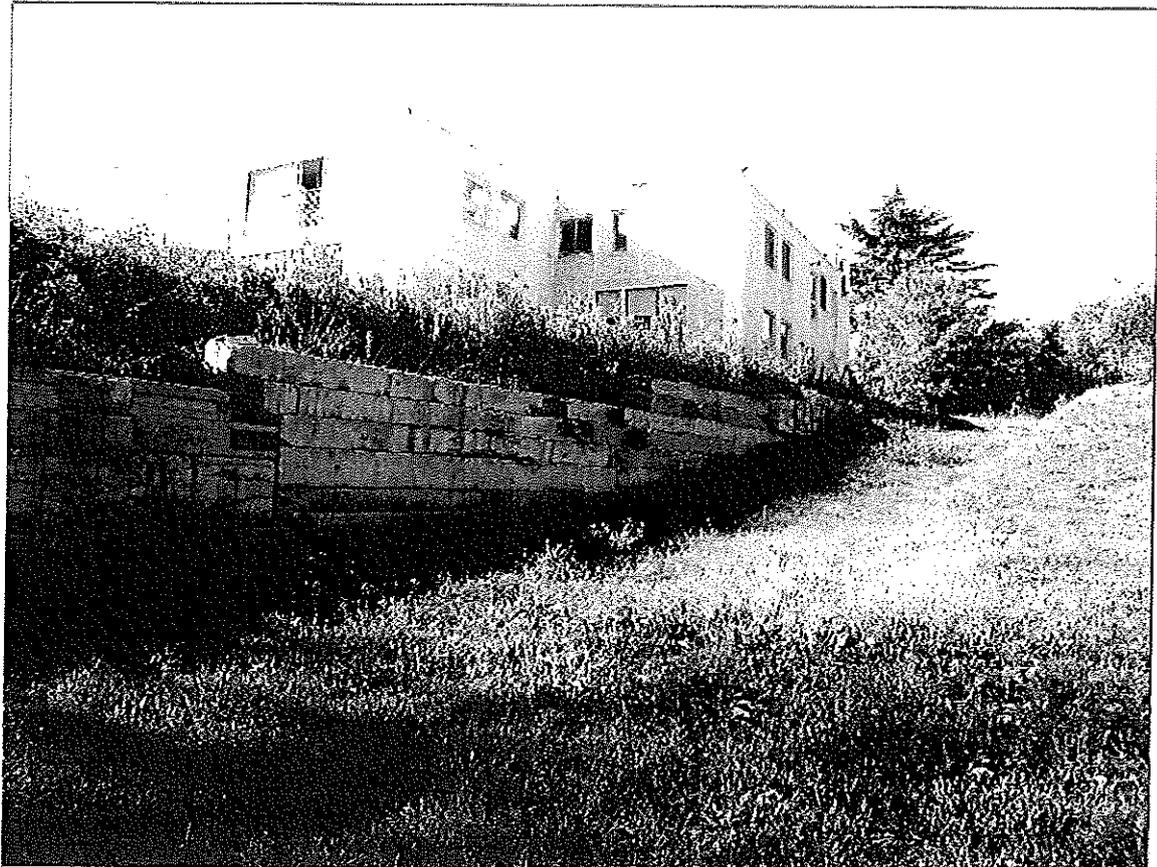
Lato Nord del lotto - Vista del muro a "secco" di sostegno scarpato
